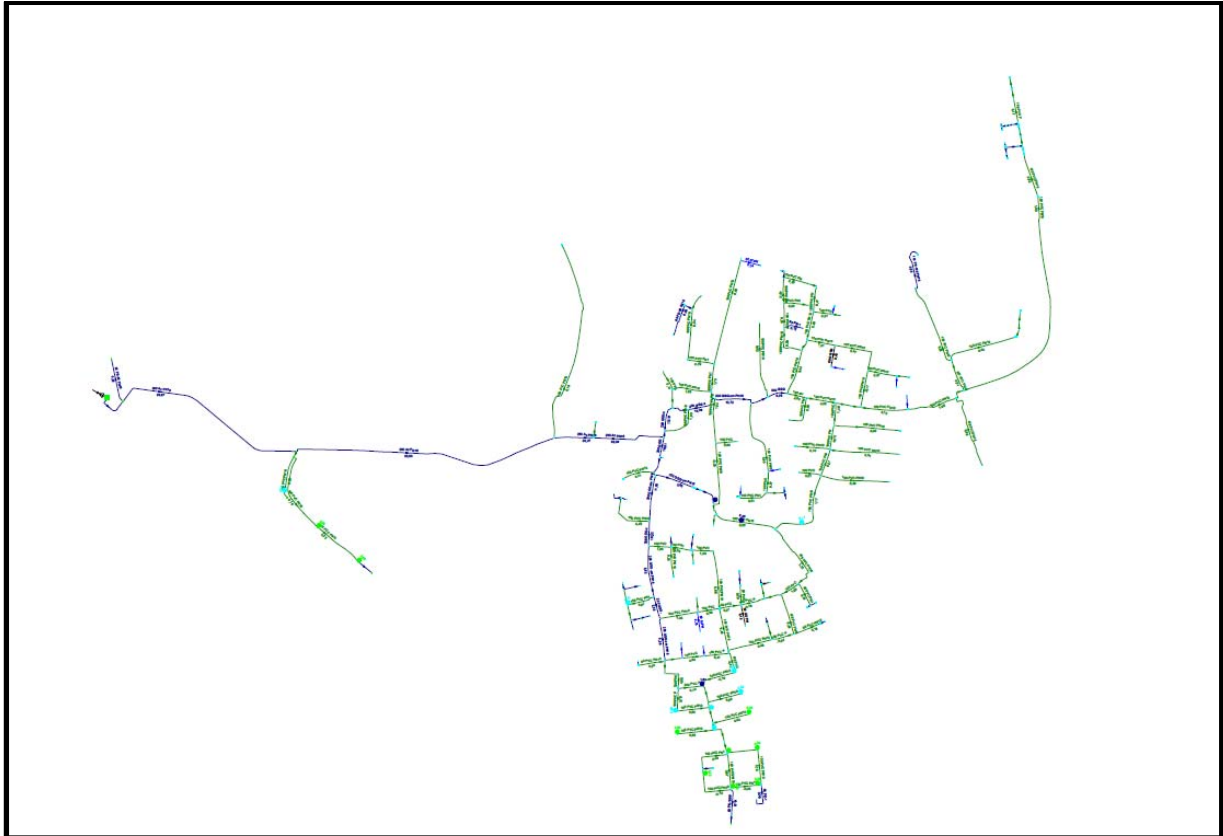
Hydranten-Plan Albersloh (blaue Punkte: Hydranten)
